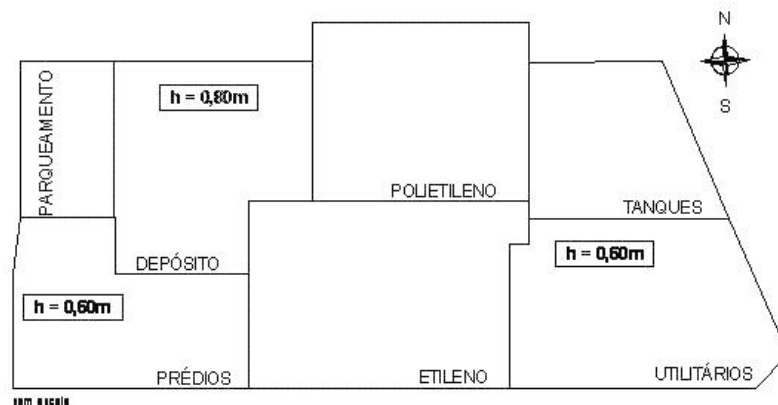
Planta baixa esquemática do aterro (Formigheri, 2003)
